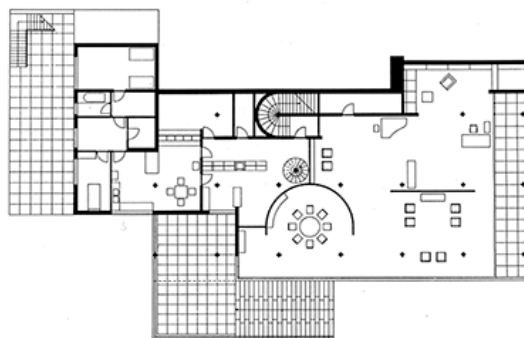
Mies Van der Rohe, planta baja casa Tugendhat, 1929
